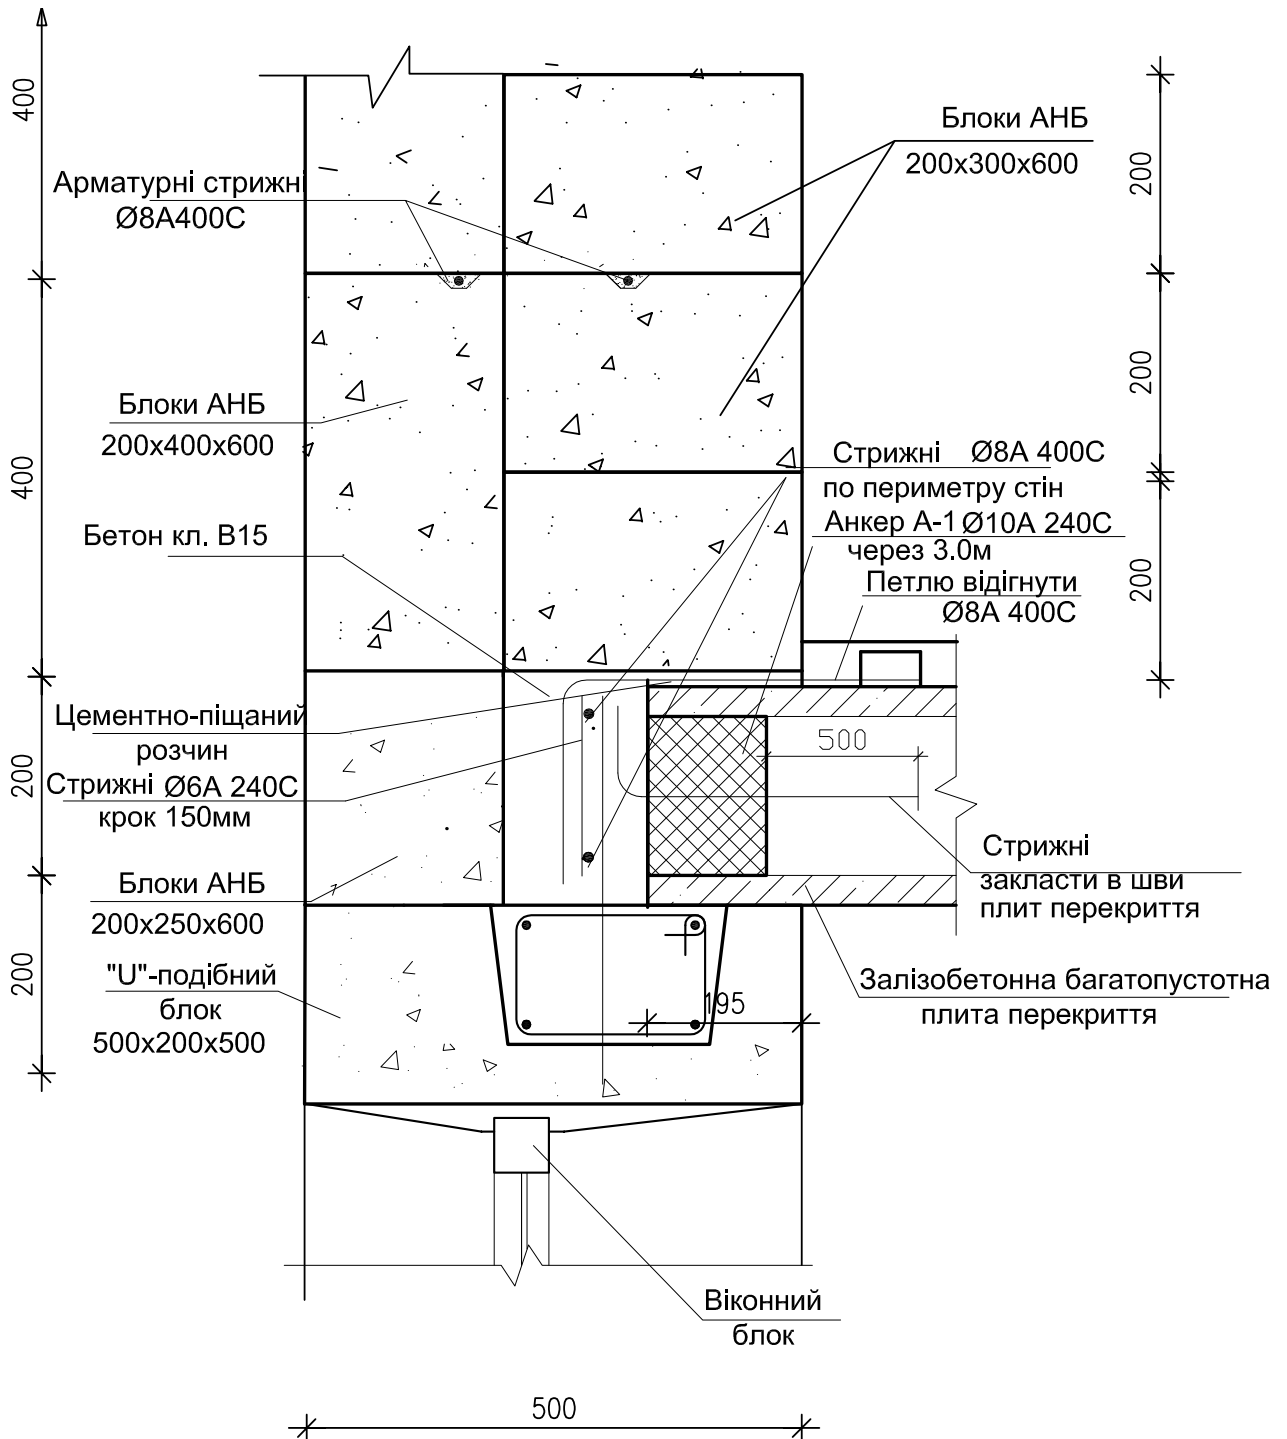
Двошарова стіна другого типу. Вузол спирання плити перекриття.
